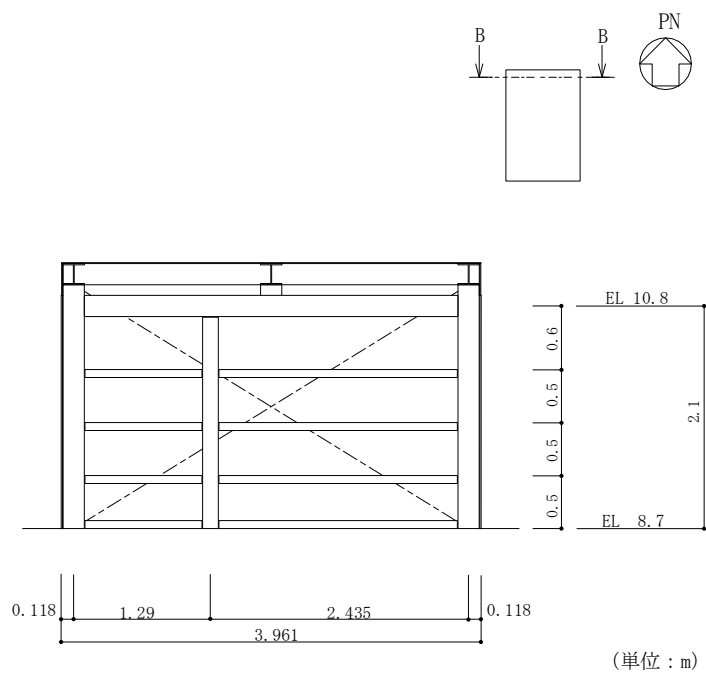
ディーゼル燃料移送ポンプエリア防護対策設備（南側）の平面図
